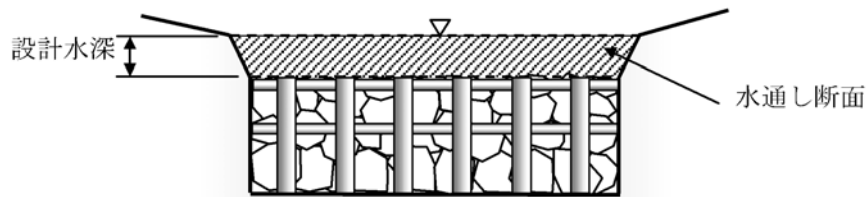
透過型砂防堰堤の水通し断面（斜線部）
